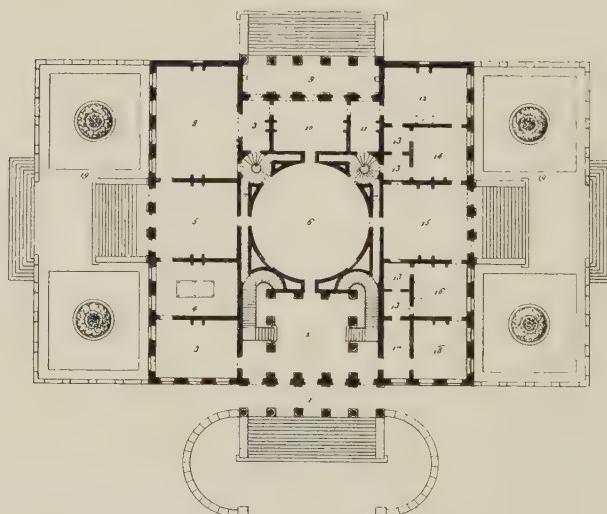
Schloß Tervueren bei Brüssel Grundriß
